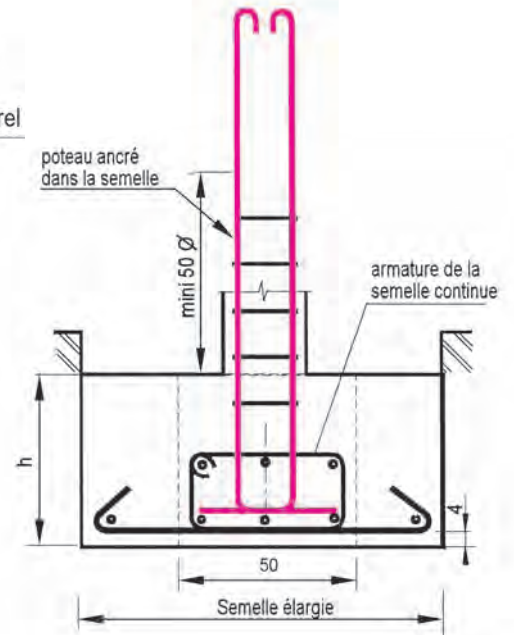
Semelle continue en béton armé élargie au droit du poteau
